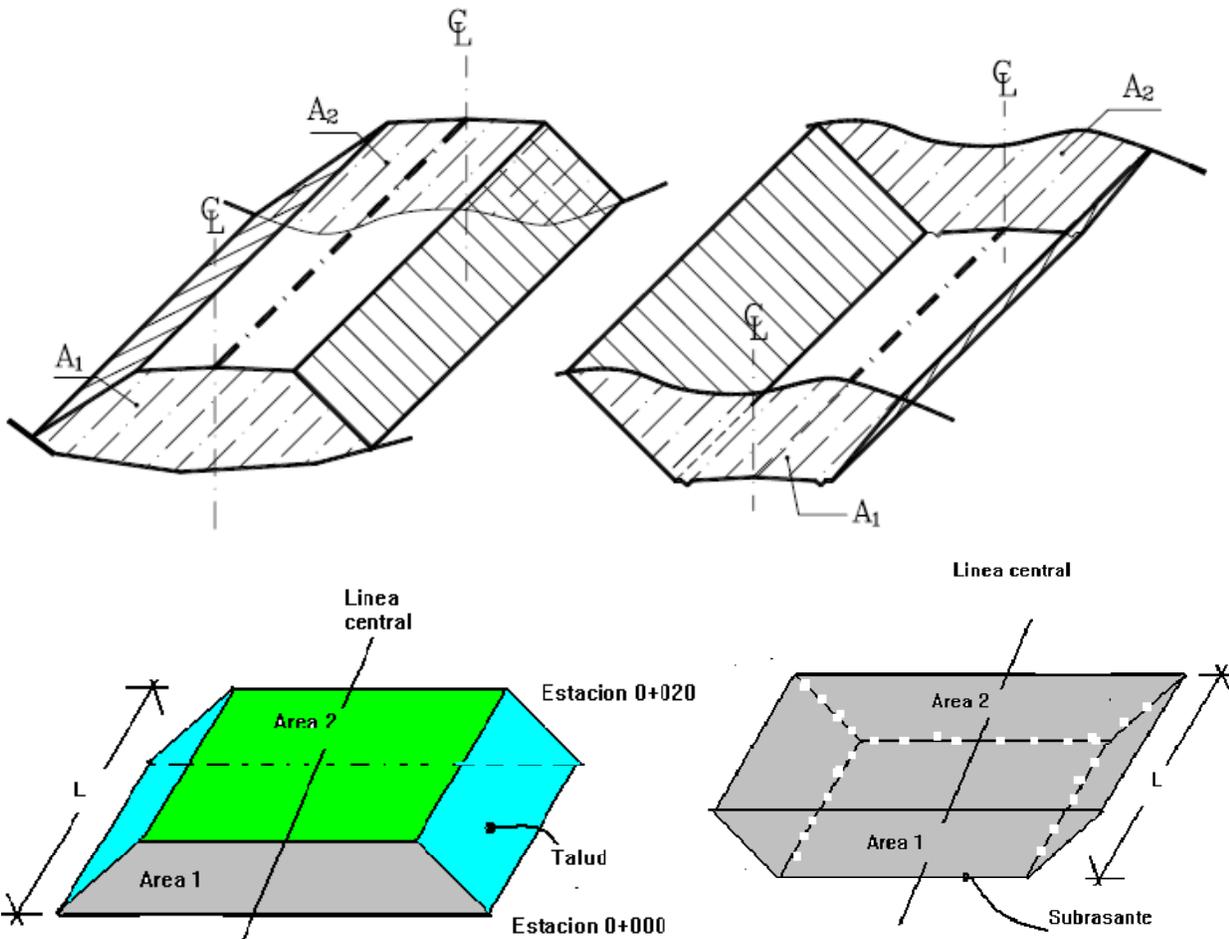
Caso 1: Las dos secciones en relleno.
